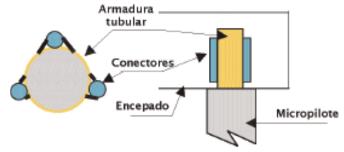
Mejora de la adherencia mediante la colocación de redondos (vista en planta y perfil)
